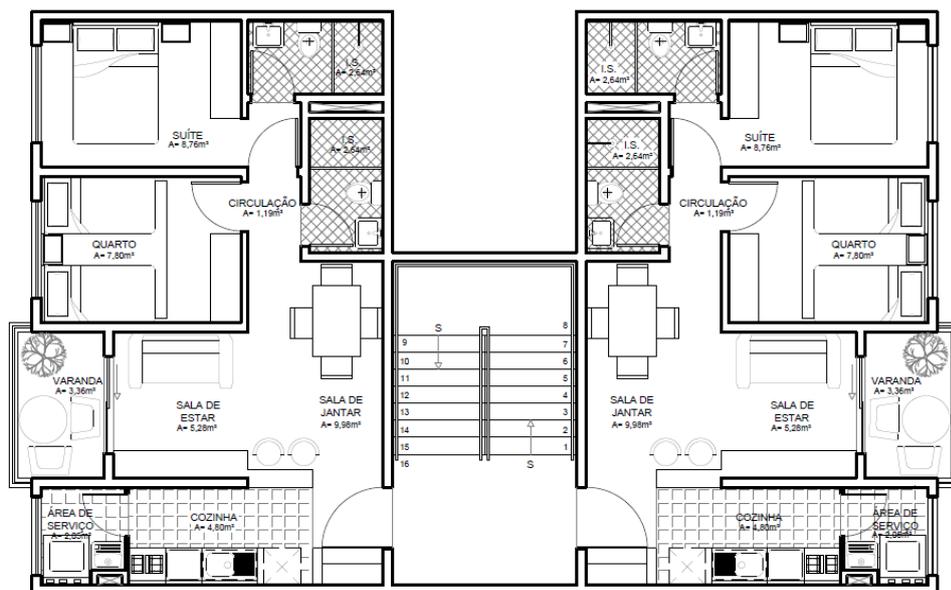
Planta baixa de apartamento de 55m<sup>2</sup>
